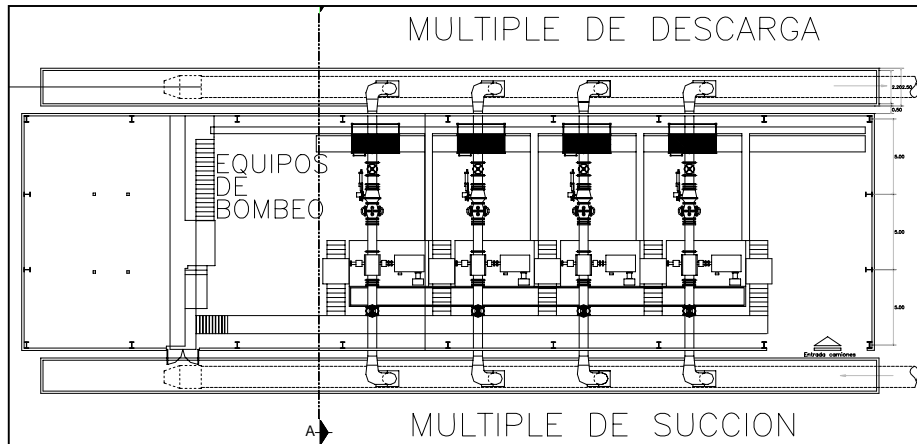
Planta de bombeo con bombas horizontales conectadas en paralelo en arreglo 3+1
